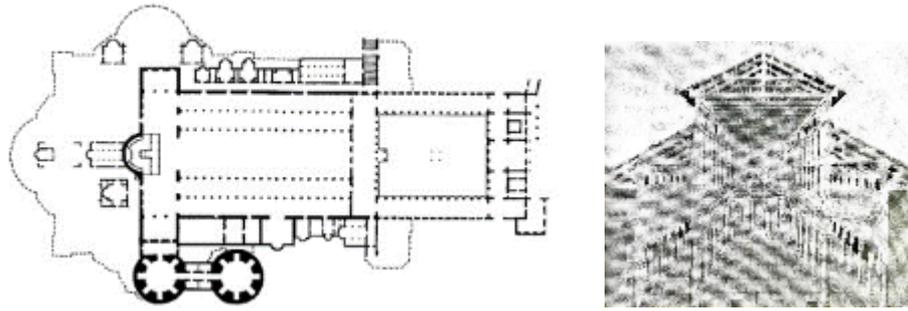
旧サンピエトロ大聖堂の平面図(左)と断面パース (右) ²⁾
